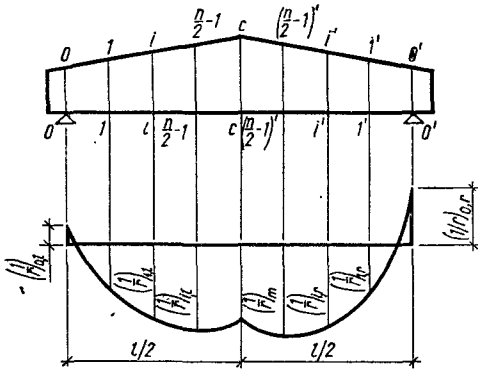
Эпюра кривизны железобетонного элемента с переменным по длине сечением.
